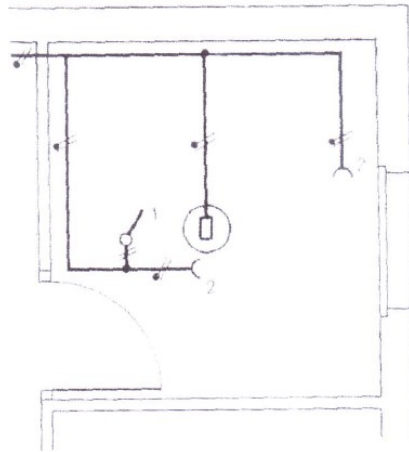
Vue en plan d'une pièce d'un bâtiment
